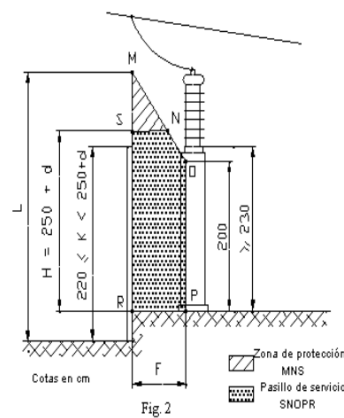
DISTANCIAS AL CIERRE PERIMETRAL
